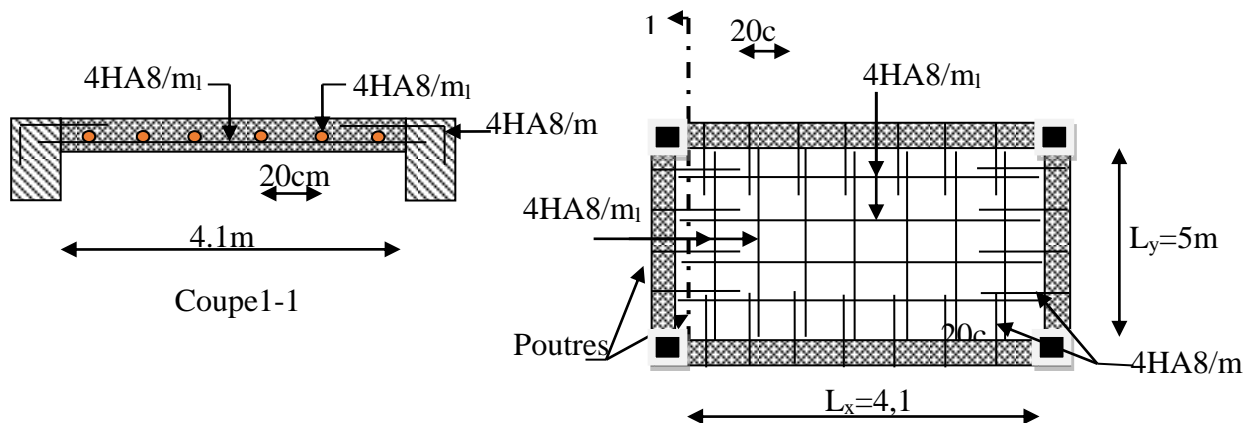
Schéma de ferrailage des dalles RDC et D1
